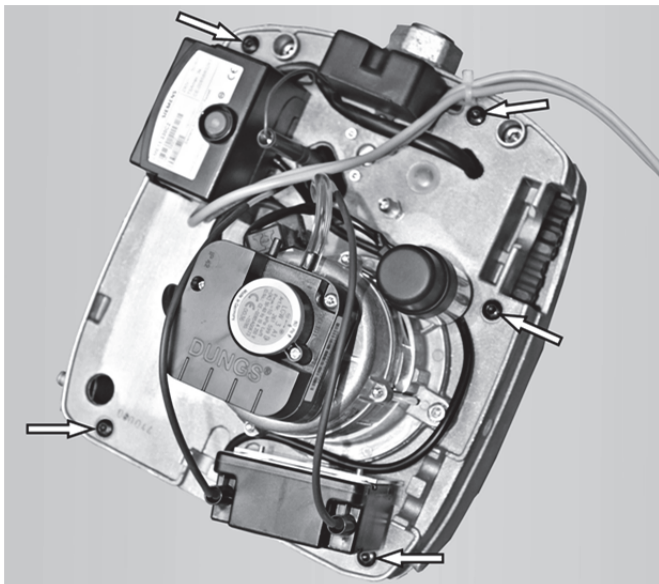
Gehäusedeckel mit 5 Schnellverschluss-Schrauben
